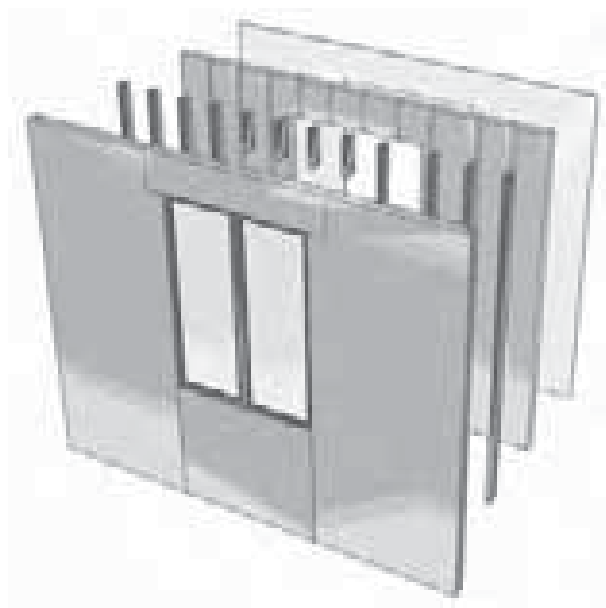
Preassemblaggio di una parete con struttura, infissi e rivestimento.
